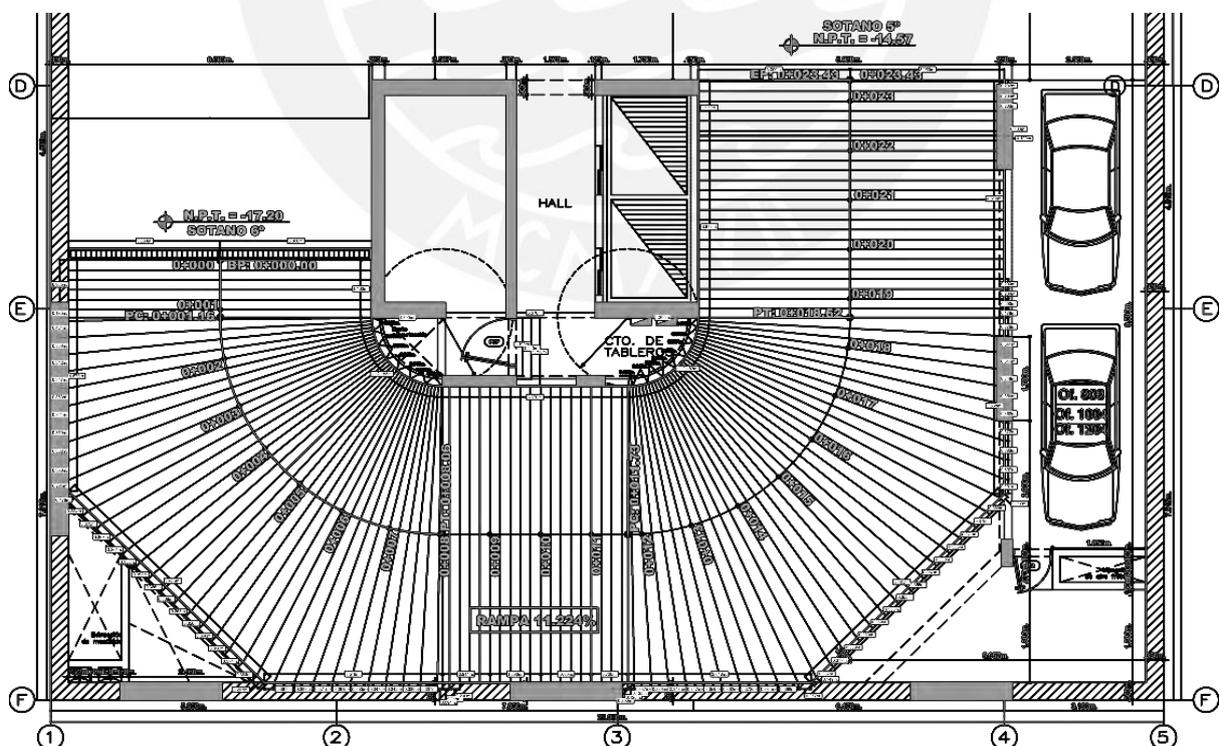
Sistema de soporte vertical para encofrado – Sector B (Fuente propia).
